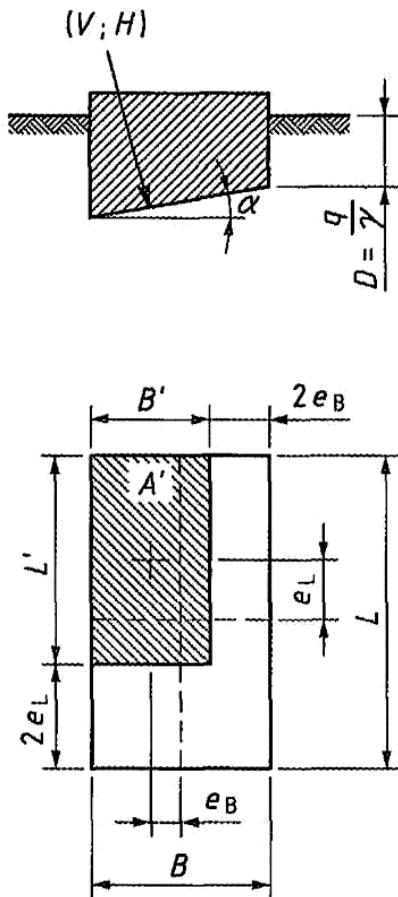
Расчетная схема и обозначения расчетных величин для определения несущей способности основания фундамента по методике EUROCODE 7
